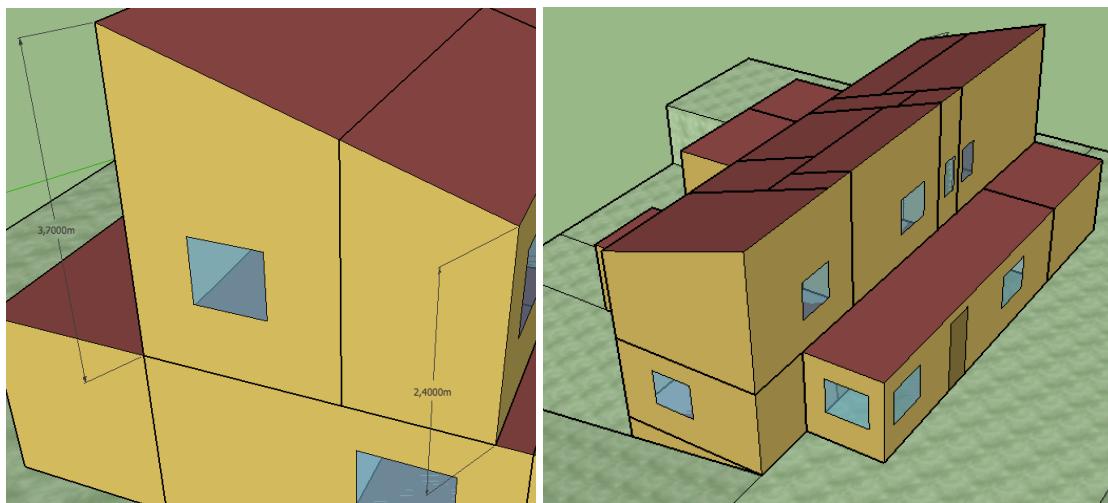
y 9: Altura planta primera y vista isométrica de la vivienda
